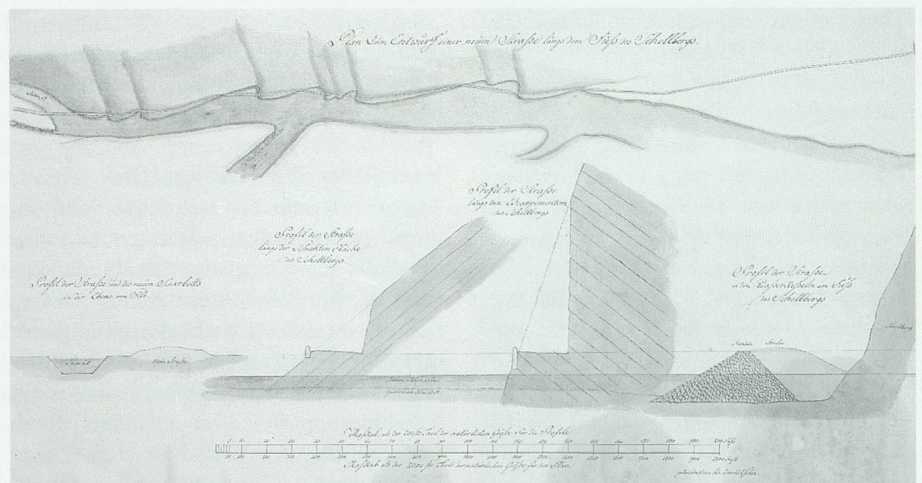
«Plan zum Entwurf einer neuen Strasse längs dem Fuss des Schollbergs»; 1810.
